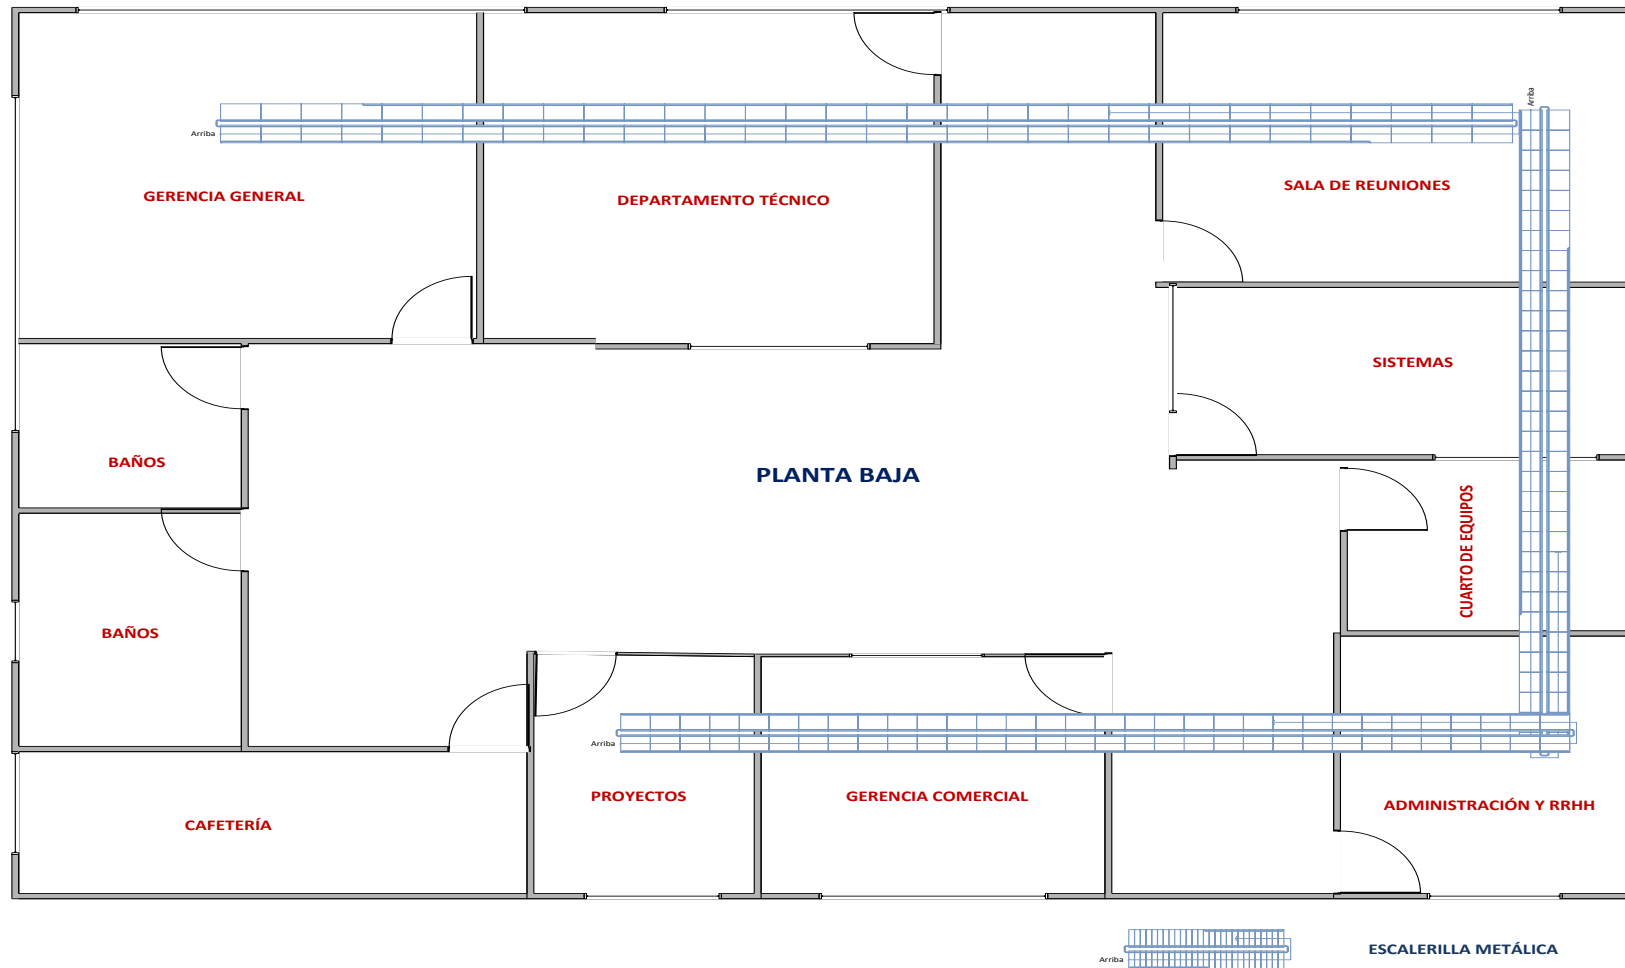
Plano de Distribución de Escalerilla Metálica Guayaquil
